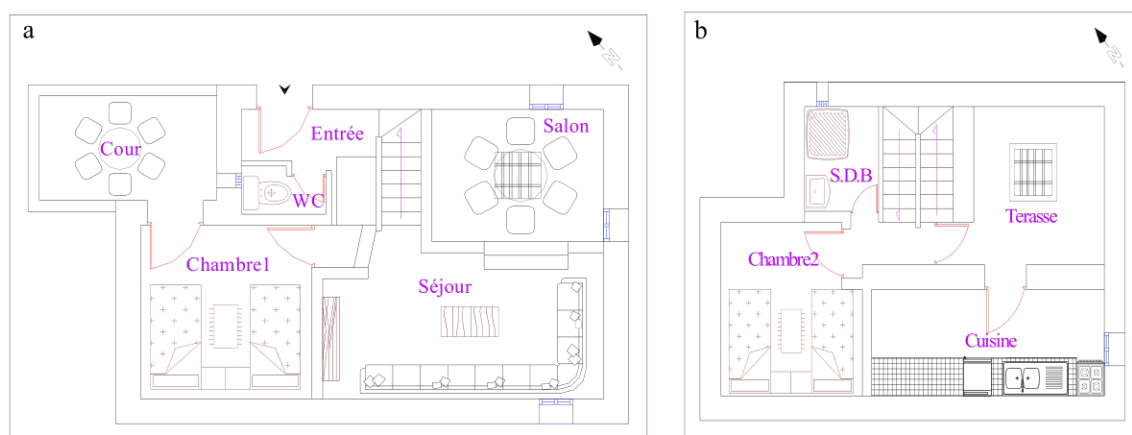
9 : a-Plan du rez-de-chaussée, b- Plan du 1er étage, du logement d'étude de cas.
